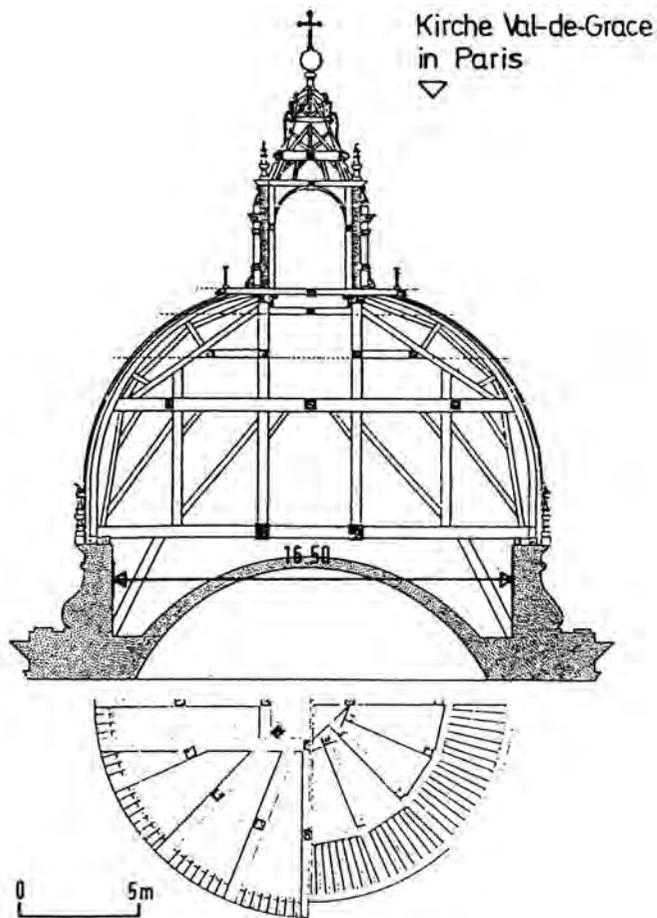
Paris, Kirche Val-de-Grâce, Querschnitt und Grundriss der Kuppel, aus /24/
